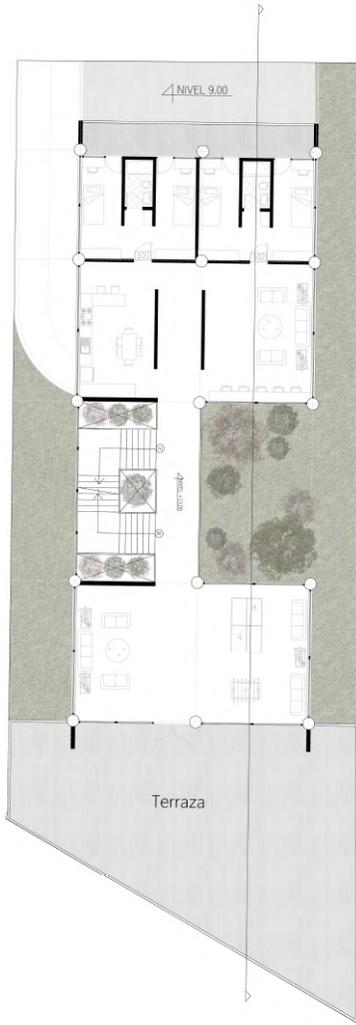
Primera planta N 13.00 Vivienda becarios. Elaboración Propia
